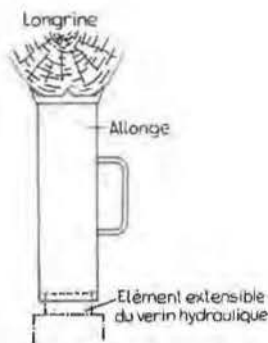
Fût d'allongement se posant sur la tête du vérin hydraulique.
